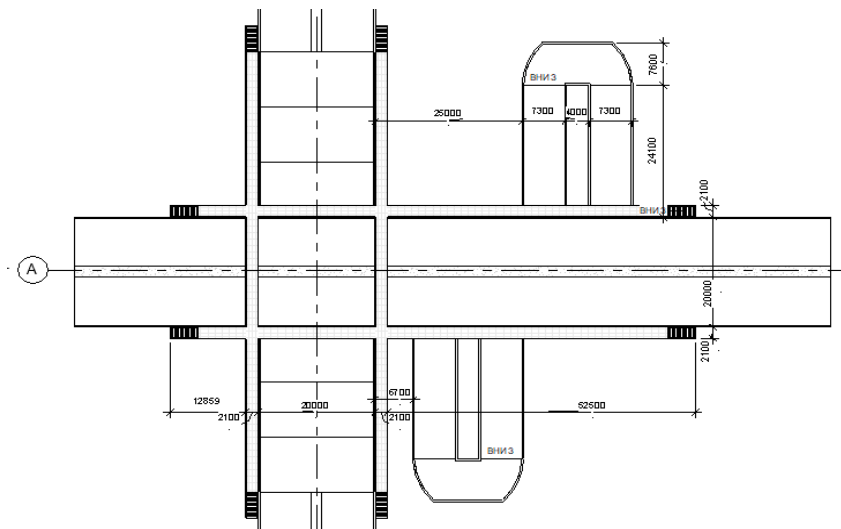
архитектурно-планировочное решение (план площадки)
